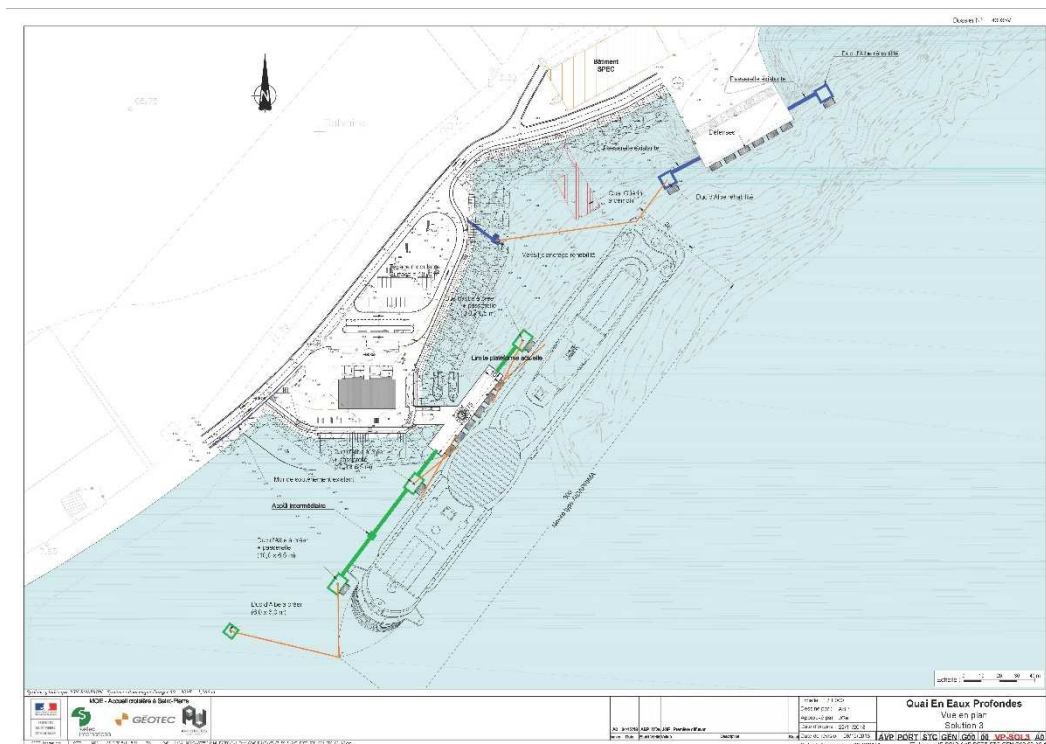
Vue en plan du projet de quai Croisière (DTAM)
